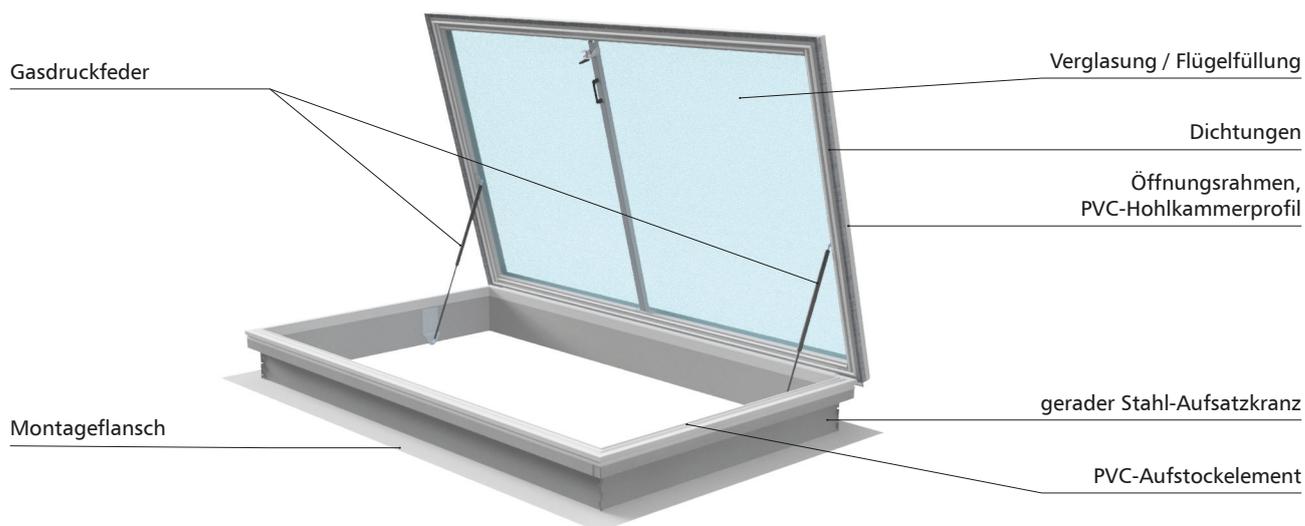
Aufbau des Dachausstiegs mcr ULTRA THERM Typ E
